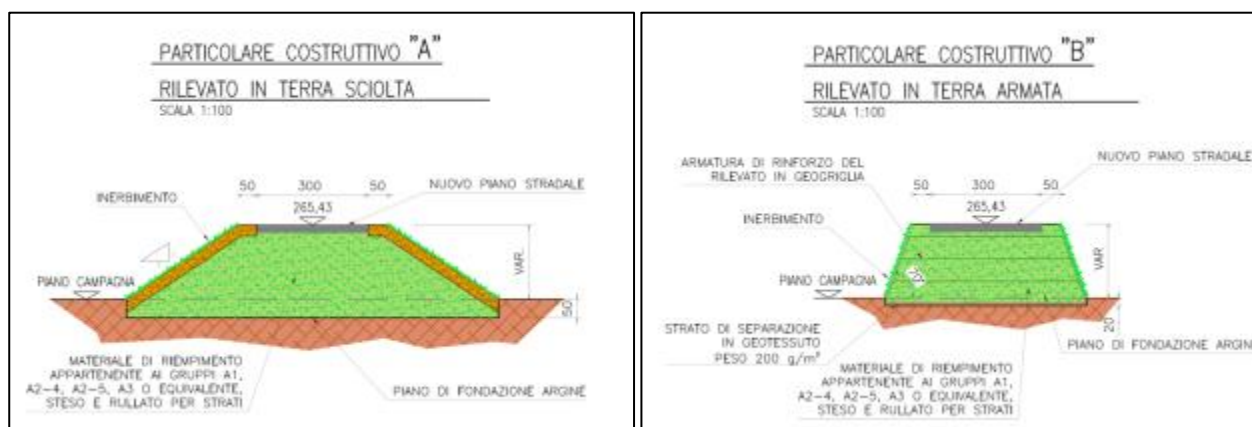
sezione trasversale delle due tipologie di rilevati previsti
